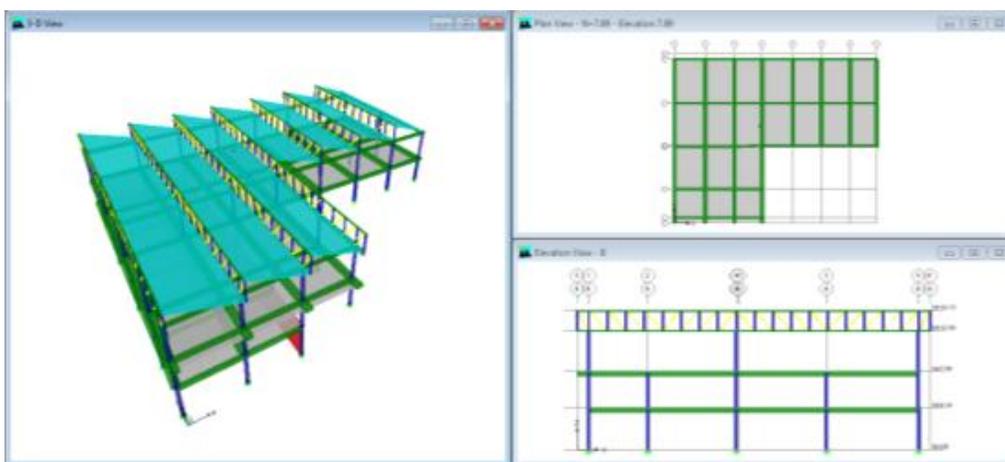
Modelo tridimensional (Estructura 8.1)
